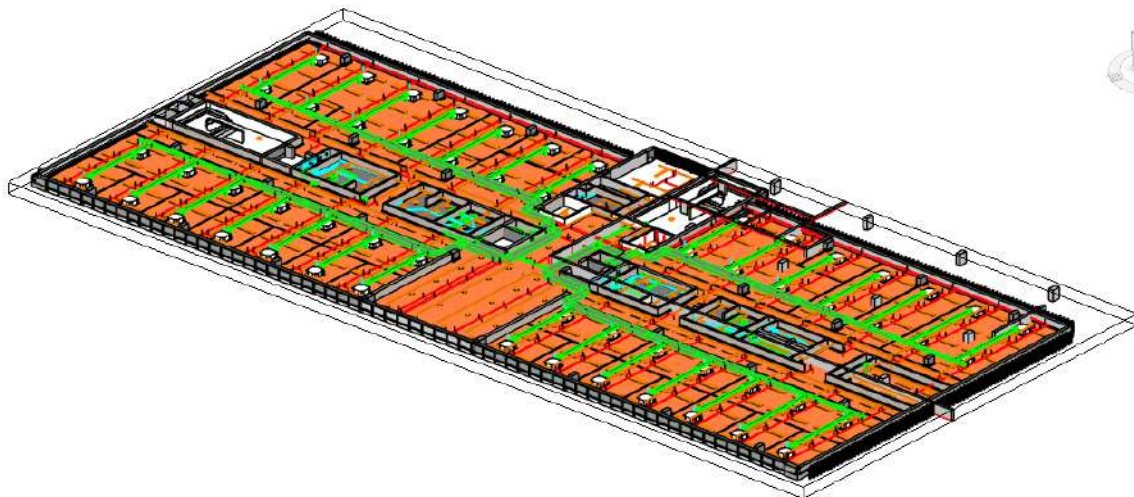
Pavimento Tipo (compatibilização) - Modelo Federado - PJSO - Sobradinho
